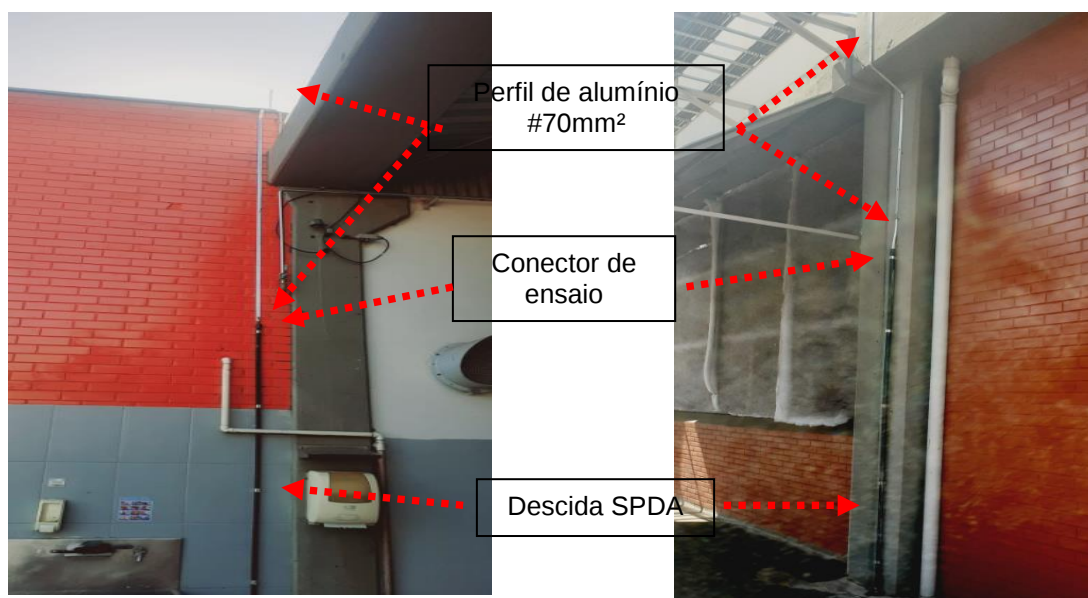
e 160: Interligação de estrutura metálica (Ar condicionados) ao SPDA existente.
